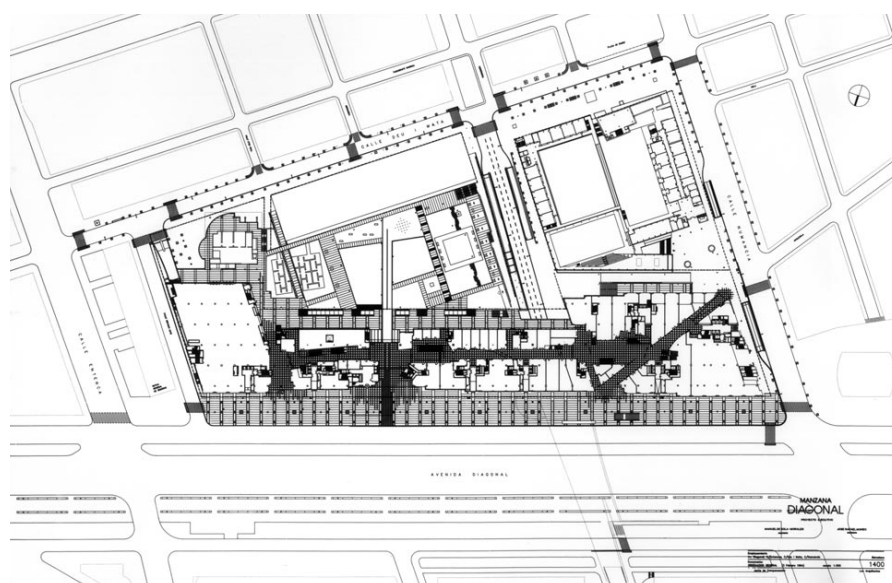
Planta baja y pavimentos de L'Illa Diagonal (1993).
